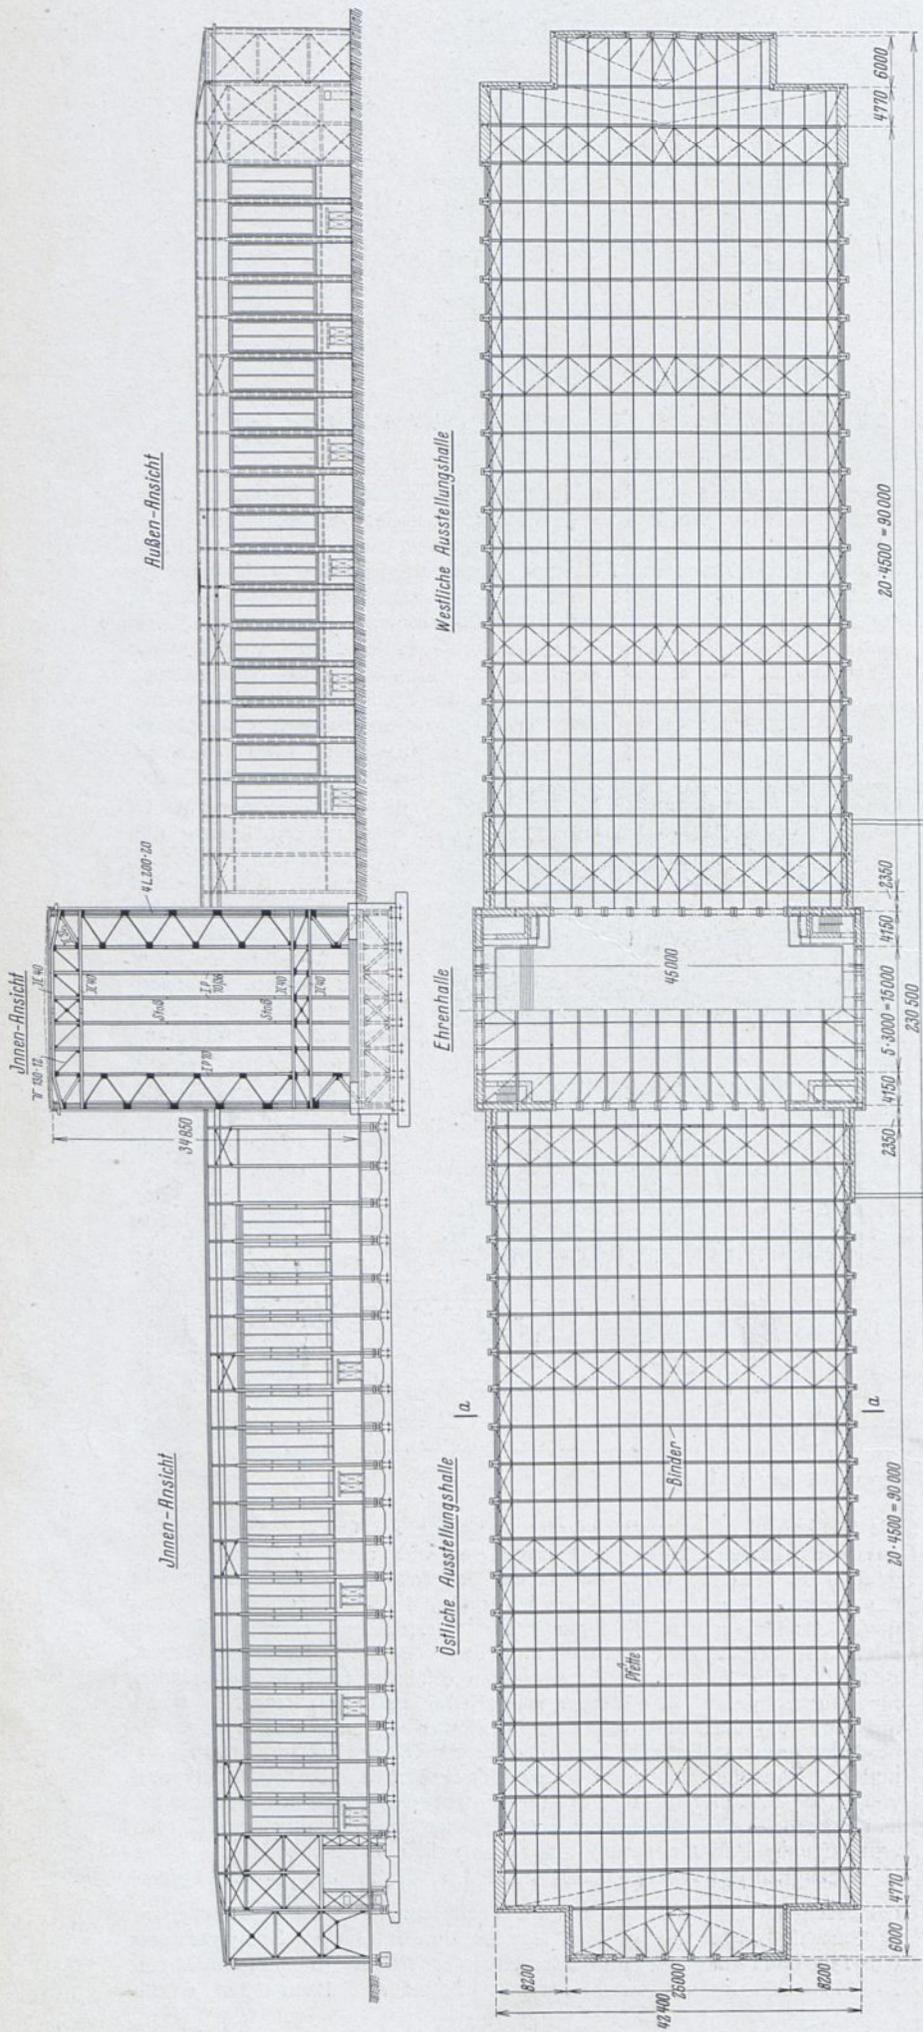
Grundriß und Längsschnitt der Stahlkonstruktion.
